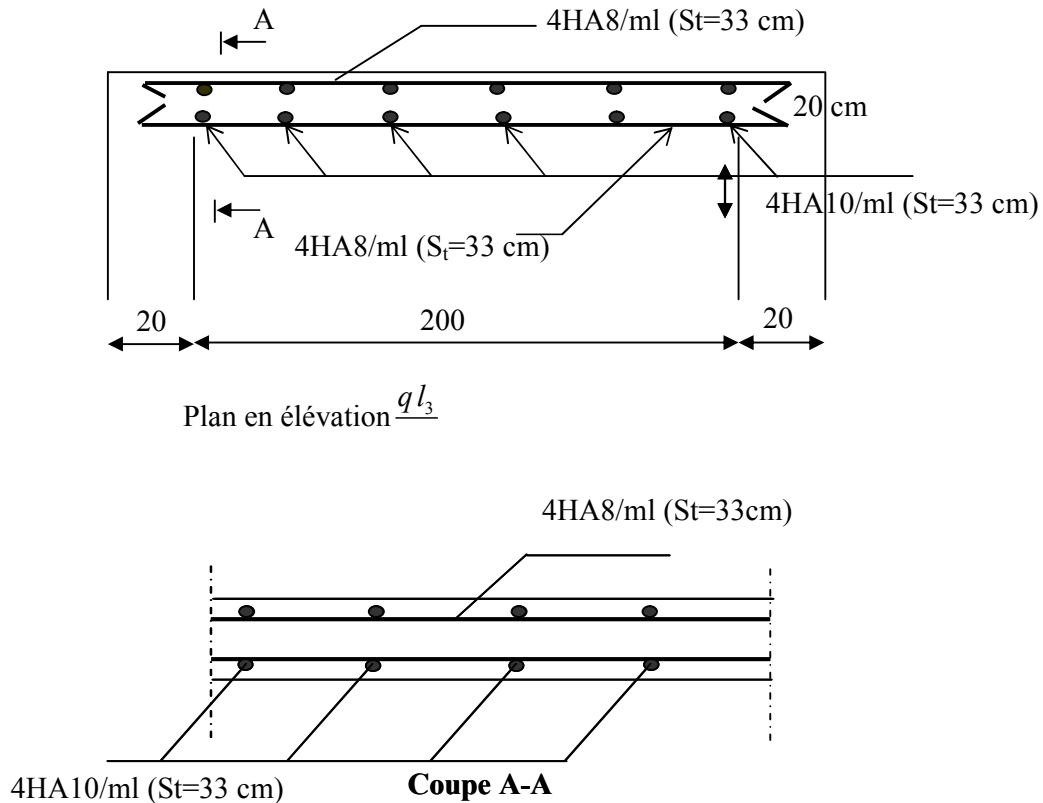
Schémas de ferrailage de la dalle du local machin
